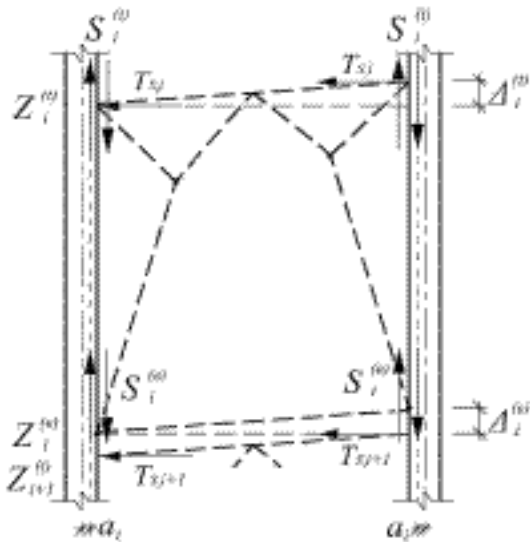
Схема усилий в узлах решетки от вертикальных смещений колонн
